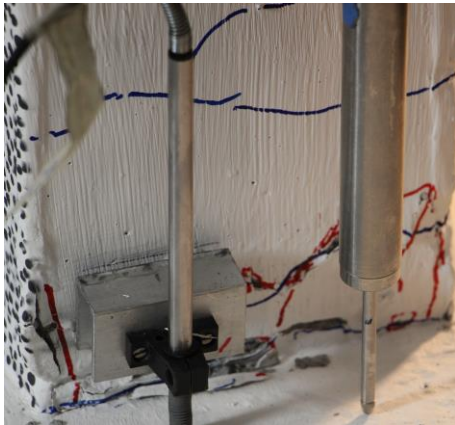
Fissures verticales de compression sur la face latérale droite de la colonne C3B au LS31
